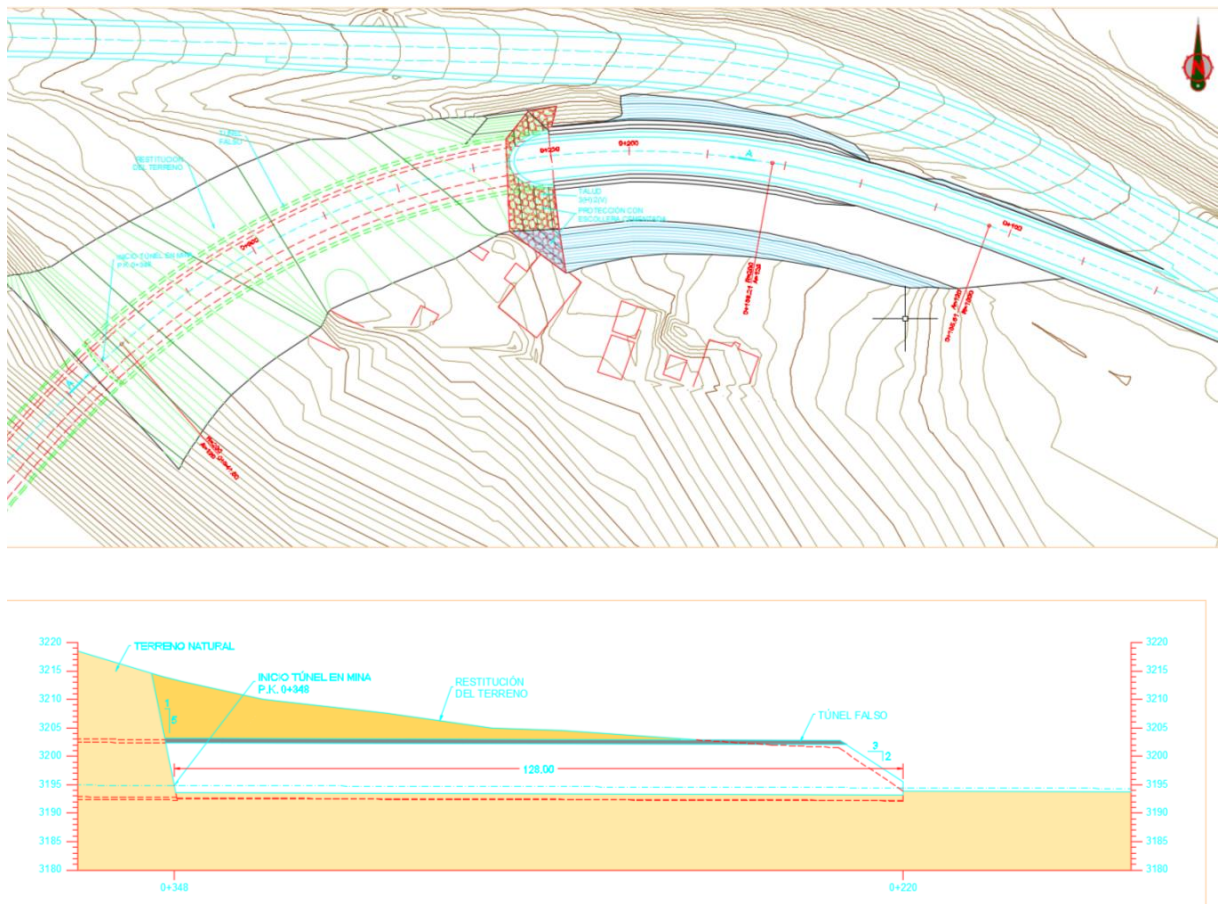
b.- Portal Argentino. Relleno en planta y alzado.
